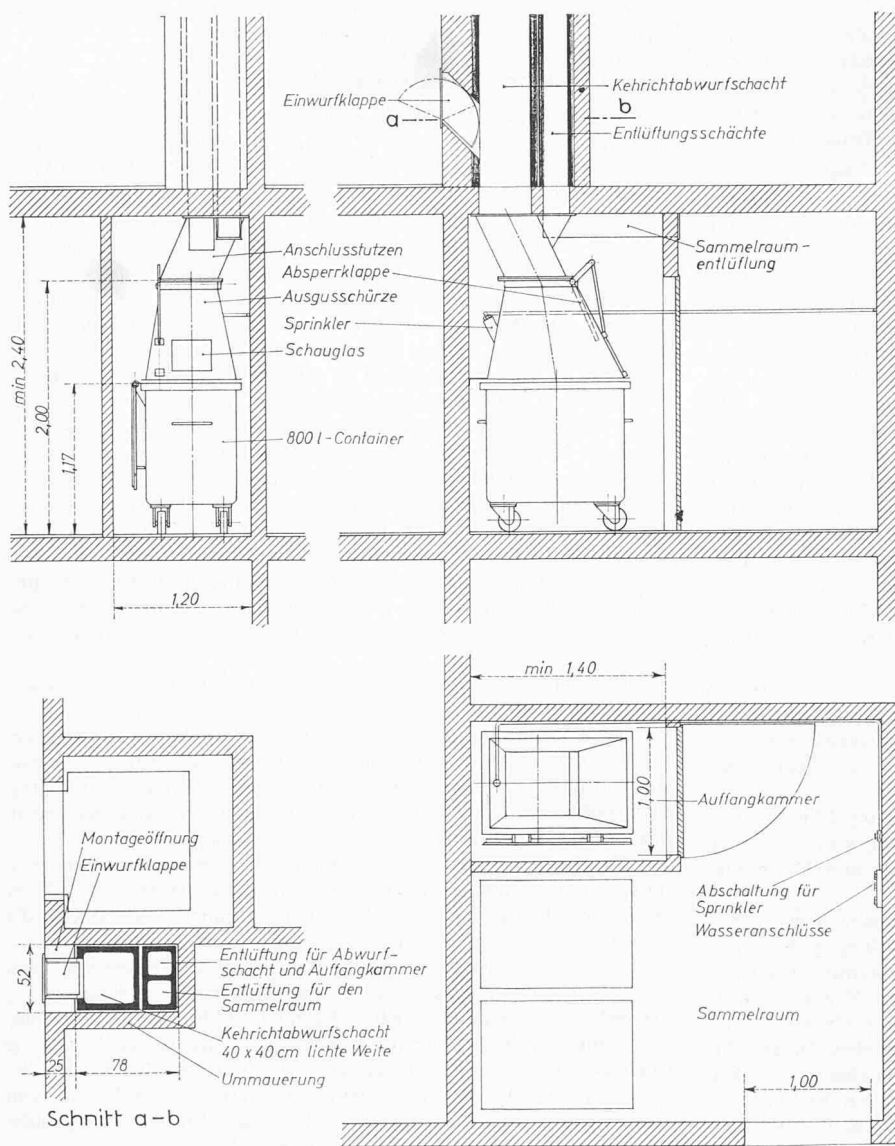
Auffangkammer und Sammelraum für Container 800 l. Grundriss und Schnitte 1:60
